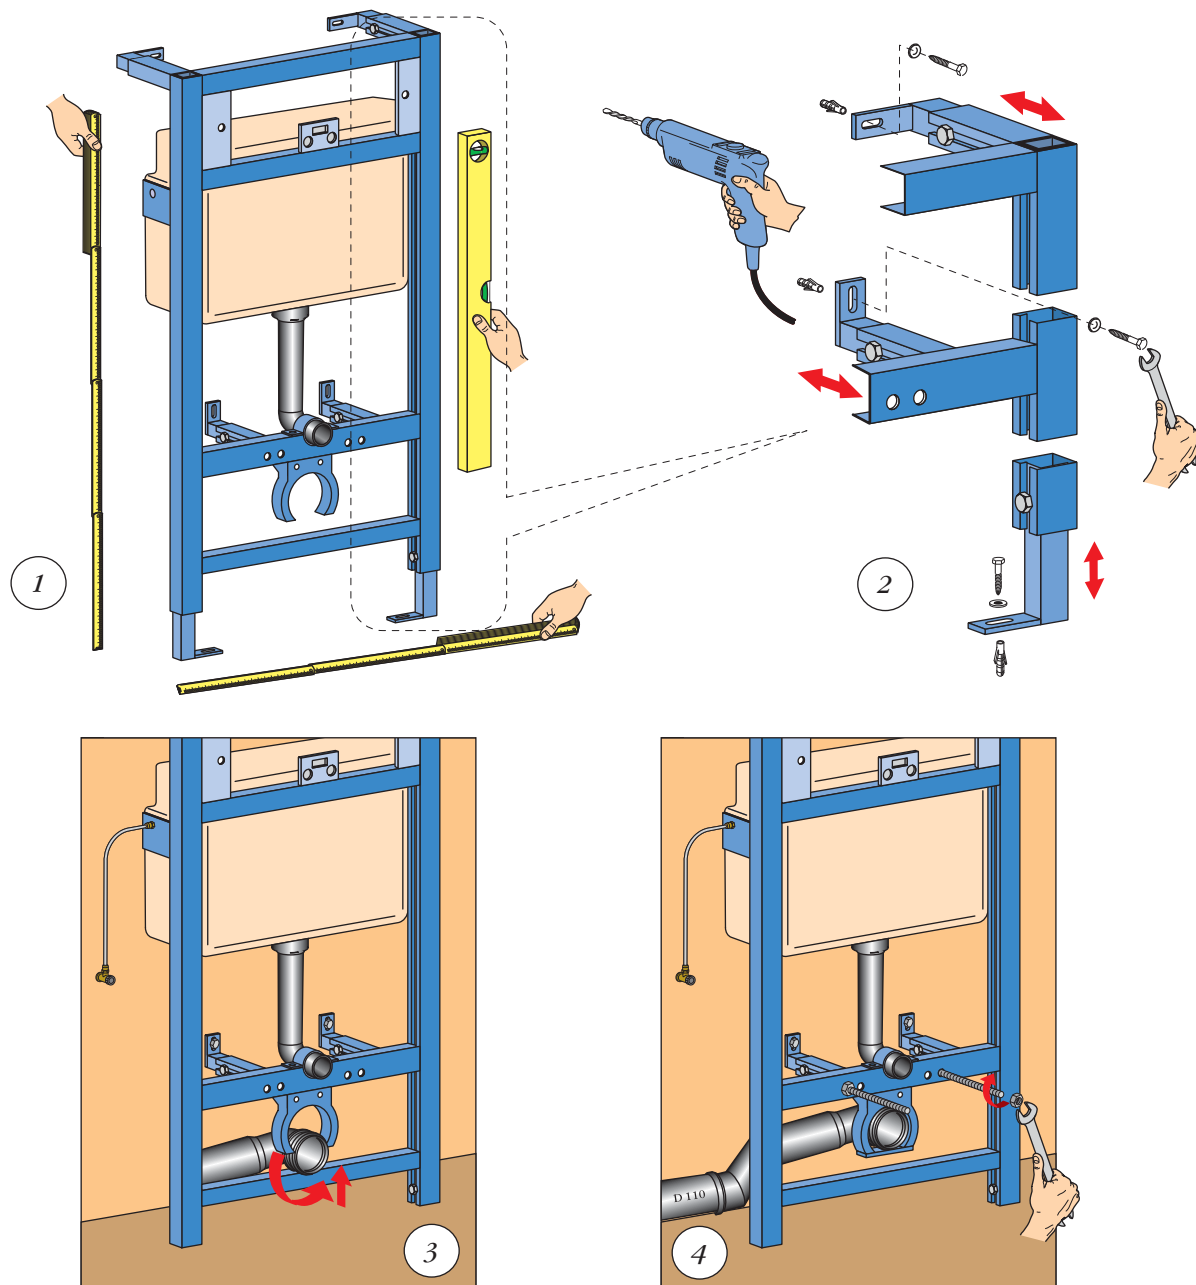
Пример установки модуля инсталляции под навесной унитаз
